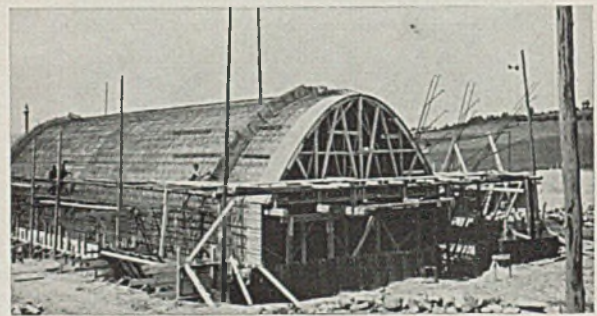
Bauwerk Nr. 208. Die im Vordergrund überstehende Spundwand ist nach Fertigstellung des Bauwerks abgeschnitten worden.
